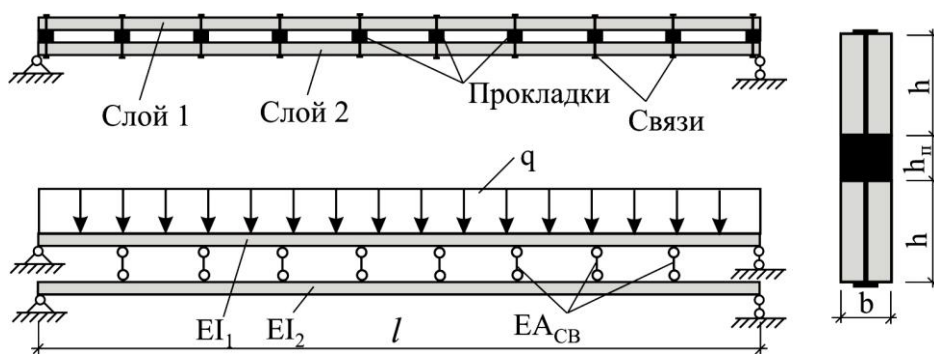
Конструкция, расчетная схема и сечение составной балки с короткими прокладками между слоями
